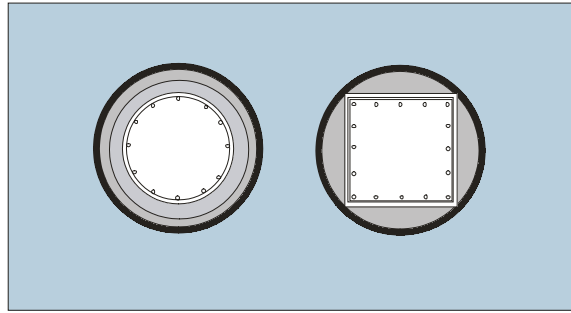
Exemple de renforcement pour les sections circulaires et carrées
